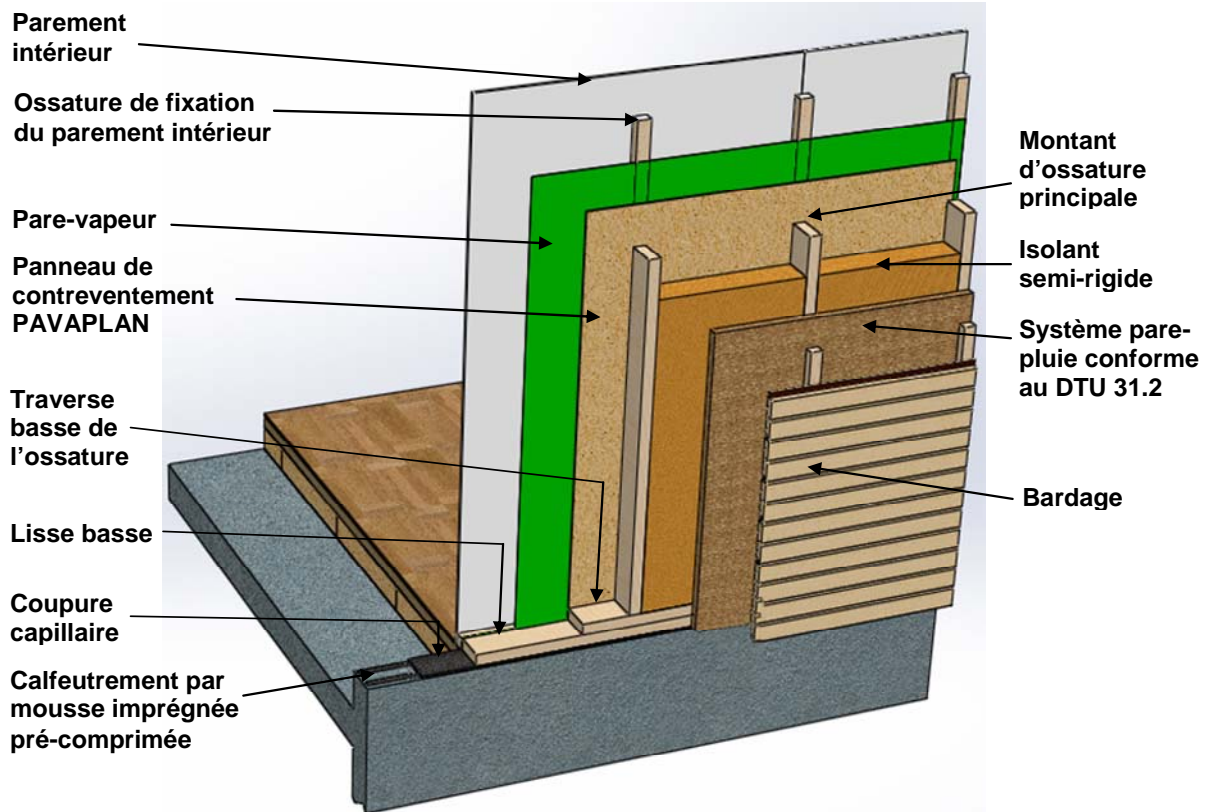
Schéma de principe d'un mur ossature bois contreventé par un panneau PAVAPLAN 8mm
